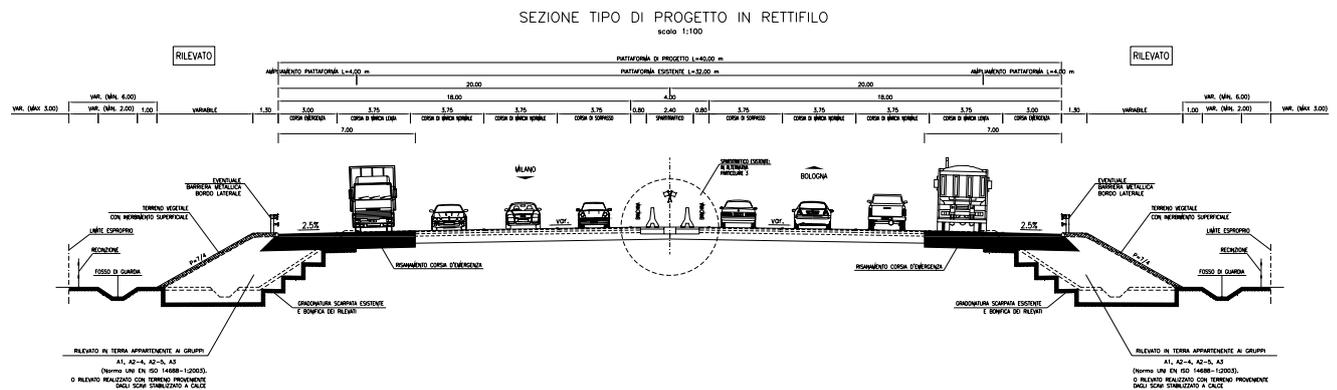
Sezione tipo di progetto in rettilineo con ampliamento simmetrico
